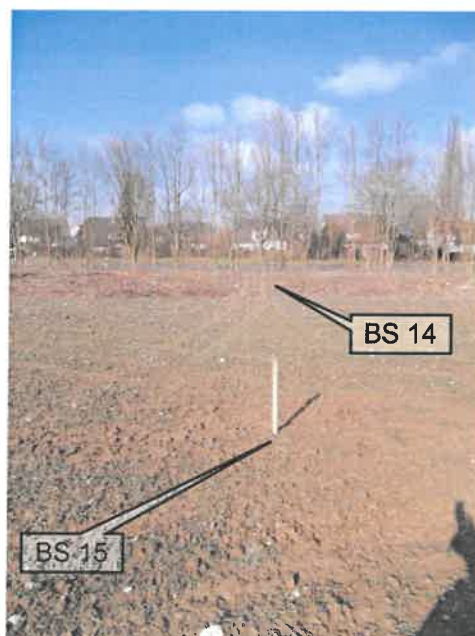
Blickrichtung ~ NNW; Bereich der BS 14 und BS 15 (Markierungen)
